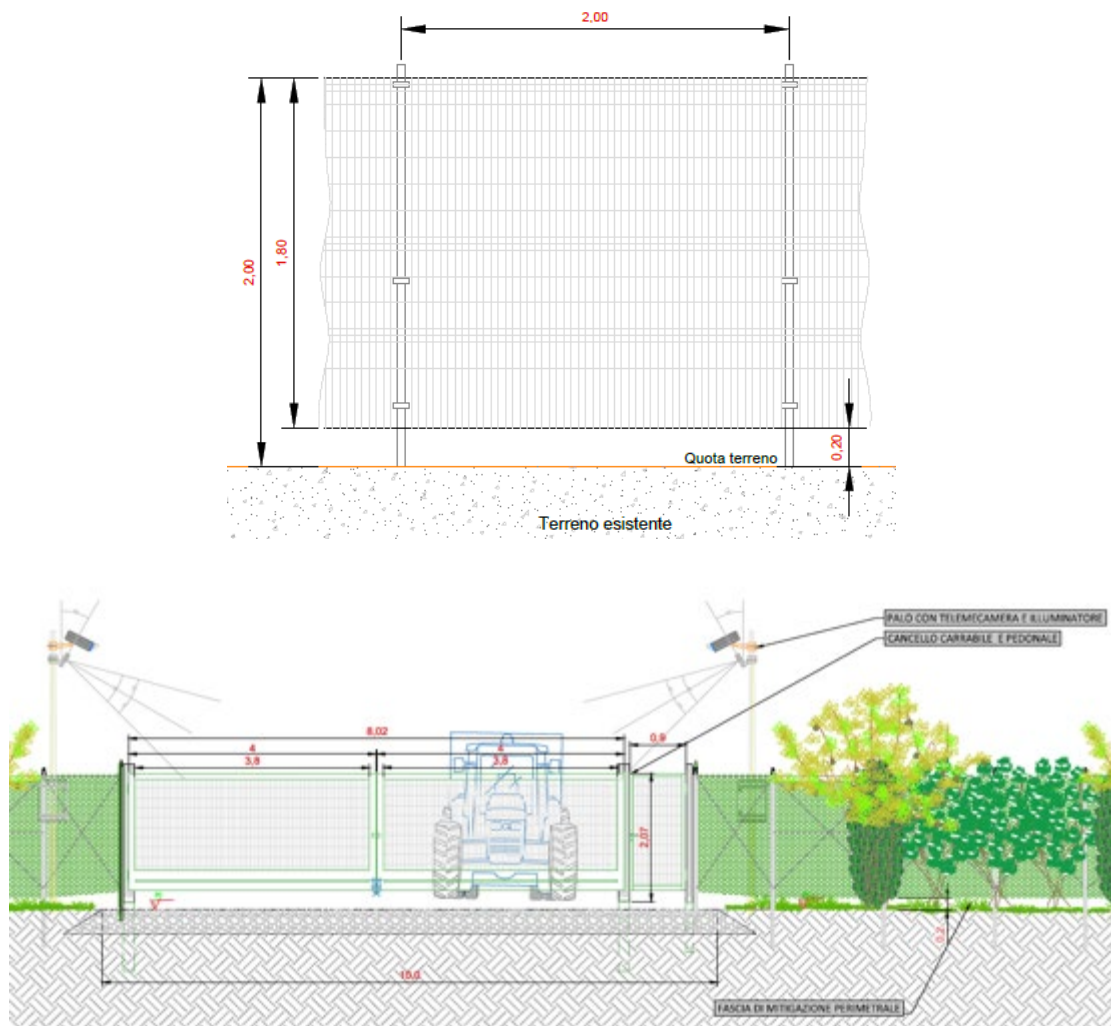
Tipico prospetto recinzione e cancelli di accesso
